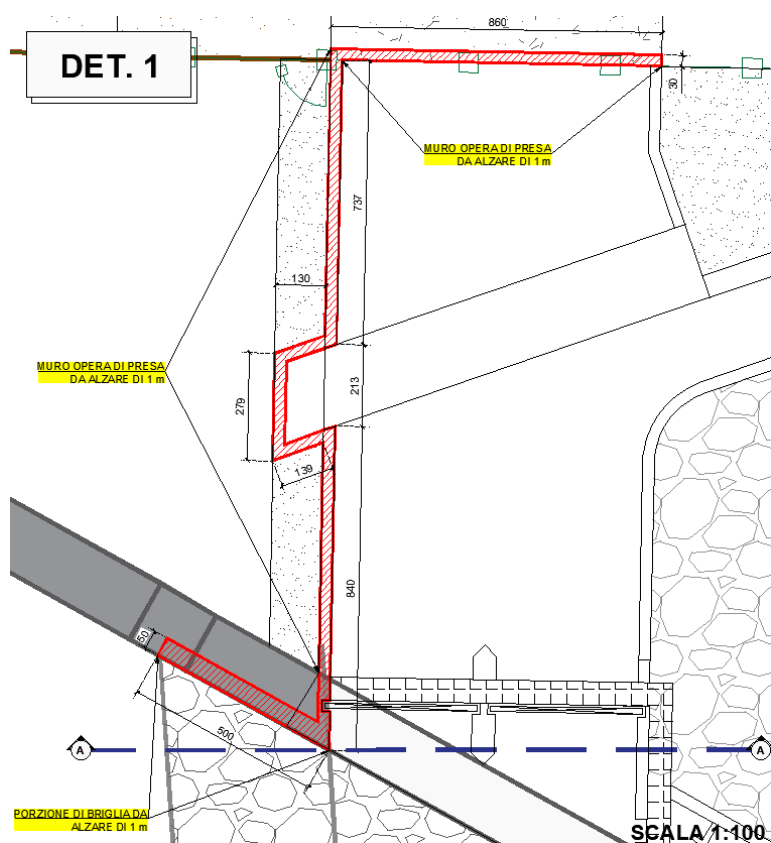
Pianta della porzione di briglia da innalzare e del muro dell’opera di presa
